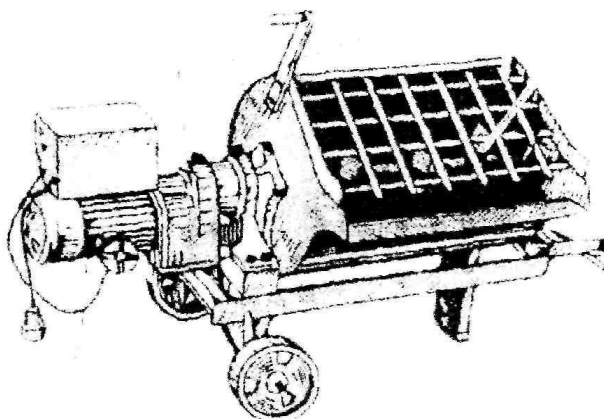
Розчинозмішувач СО-46А: 1 – візок; 2 – електродвигун; 3 – редуктор; 4 – змішувальний барабан; 5 – рукоятка; 6 – захисні ґрати; 7 – вал з лопатями.
